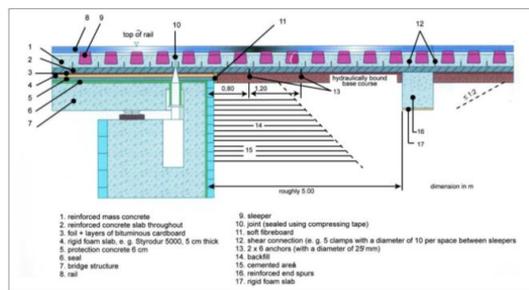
Medidas adicionales para las transiciones estructura-terraplén en sistemas de vía en placa (ÖBB-PORR), (FUENTE: Efficient Low Cost Renewal and Refurbishment Methods for Tracks in Tunnels and on Bridges and Viaducts (Urbantrack) [6])
